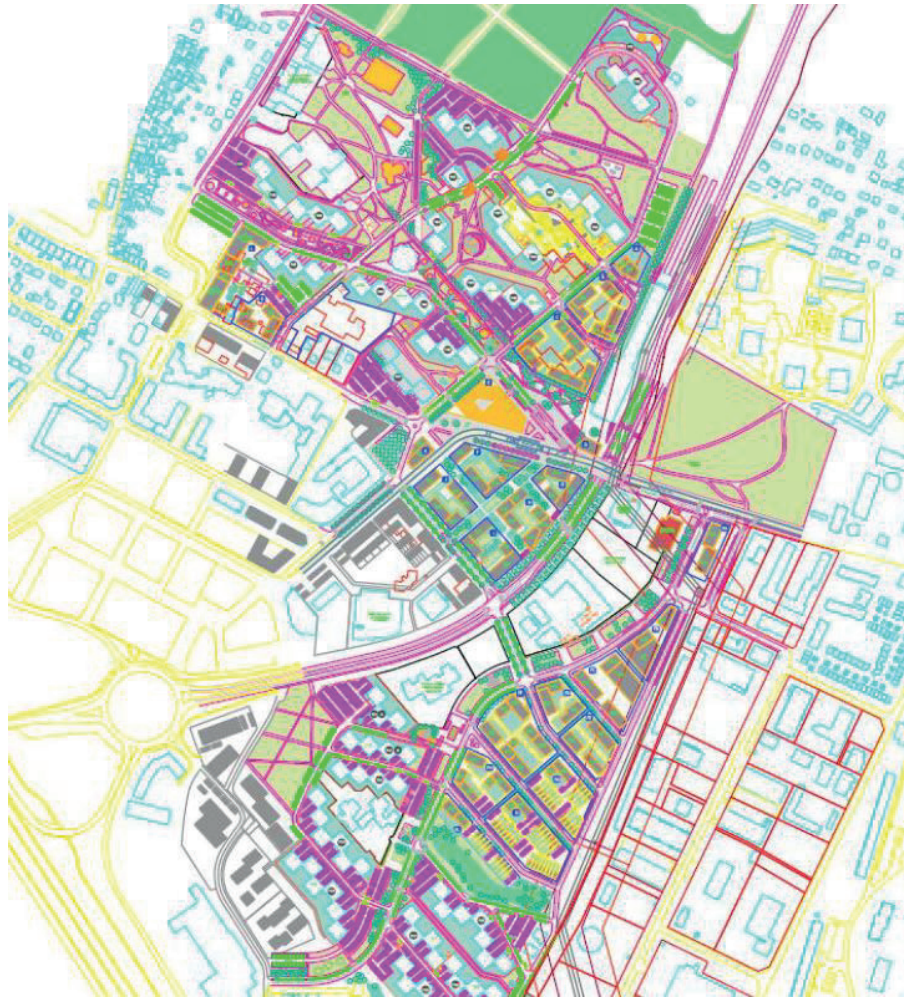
Plan des aménagements futurs (Source : Acouplus, 2020)
